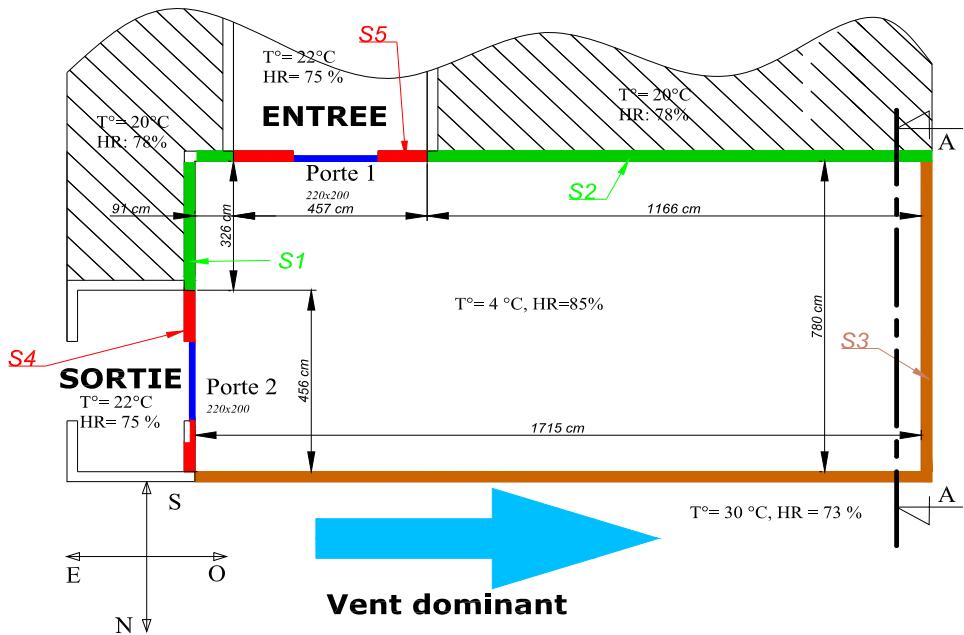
Vue de haut et dimensionnement de la chambre froide (source : Auteur)
